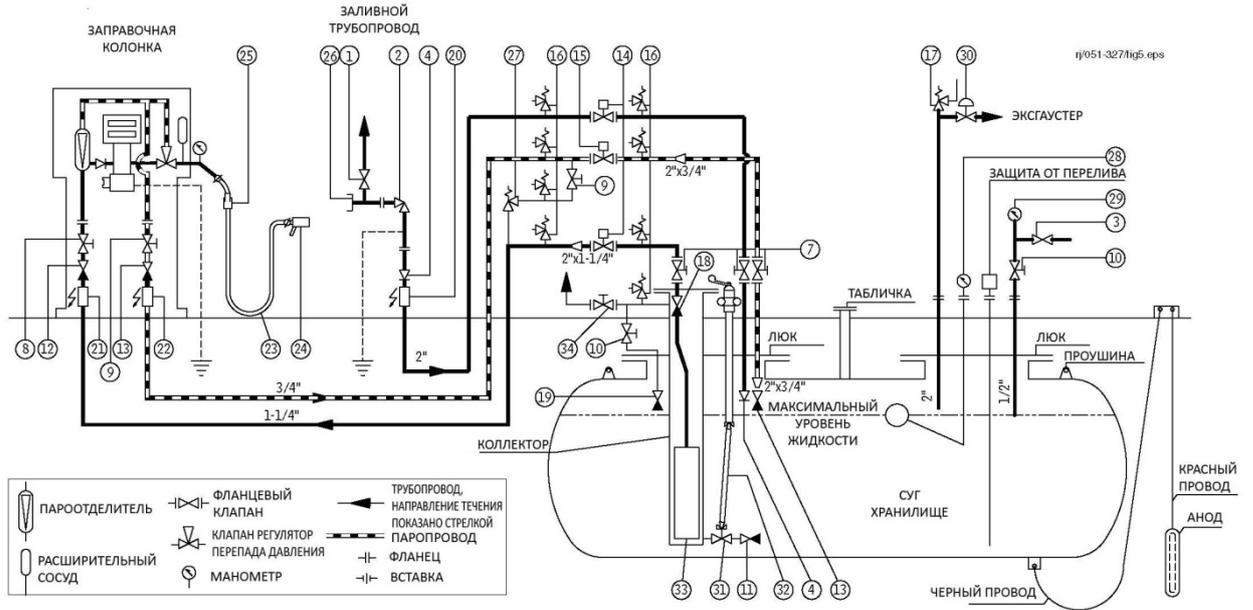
Типовая схема для подземного резервуара с вертикальным погружным насосом
